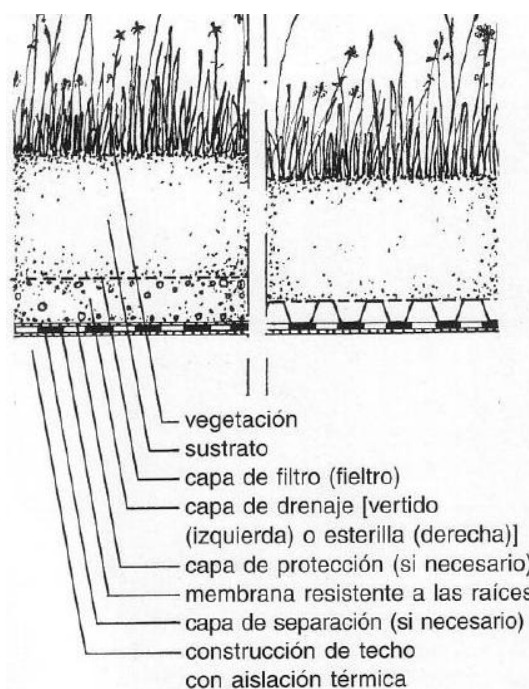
CORTE DE COBERTURA VERDE PLANA
